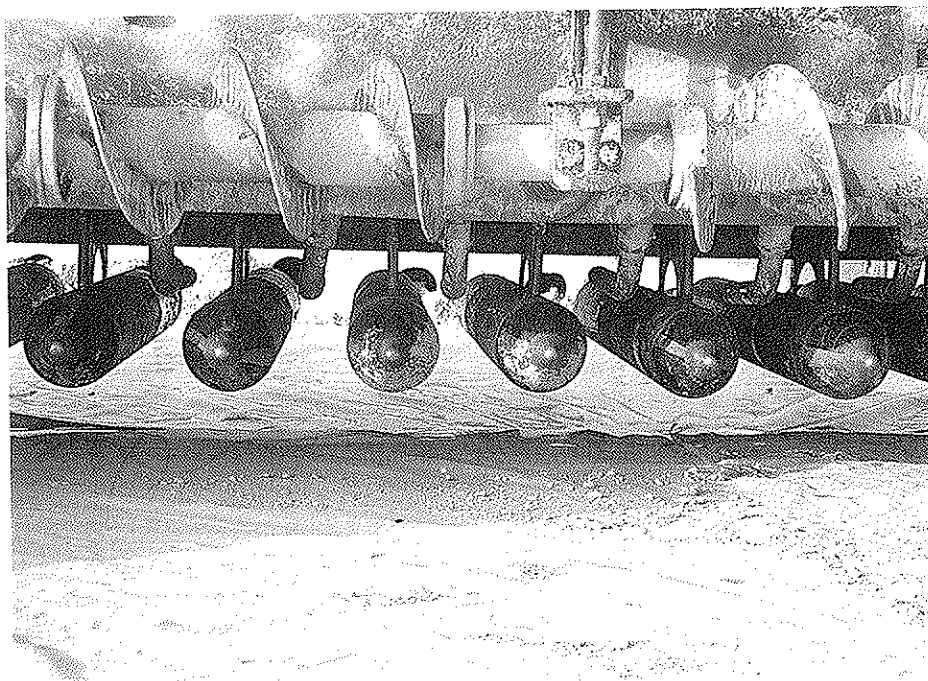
Disposición de los moldes en una extendidora de hormigón.
